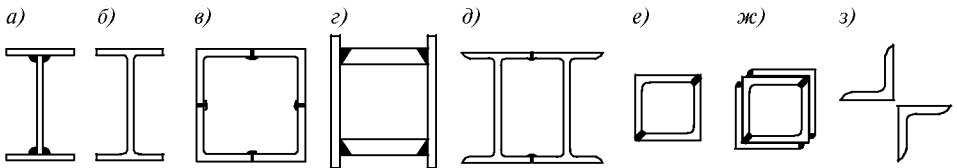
Сечения колонн многоэтажных производственных зданий и промышленных этажерок
